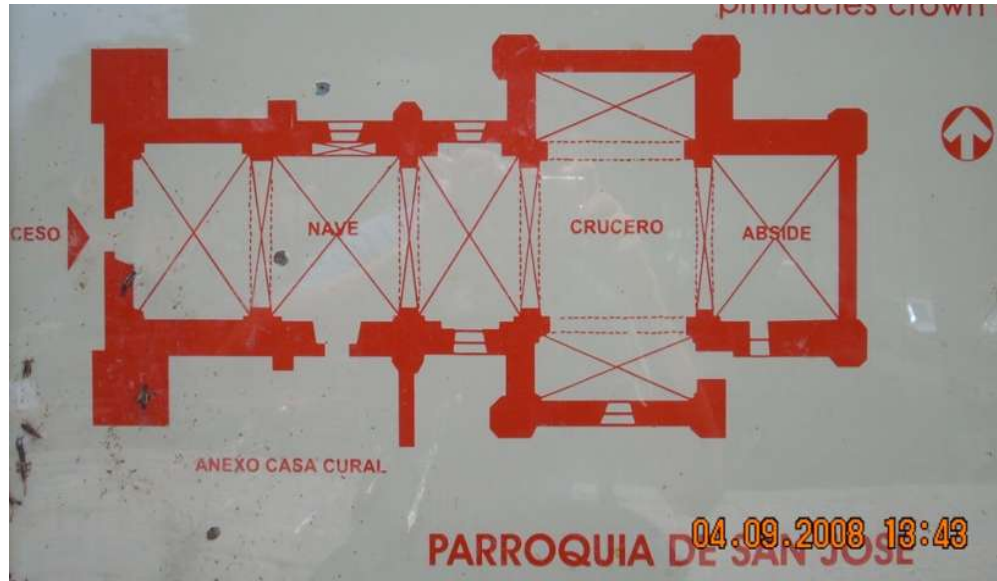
Croquis de la Planta del Templo de San José (O. Segura, 2008).
